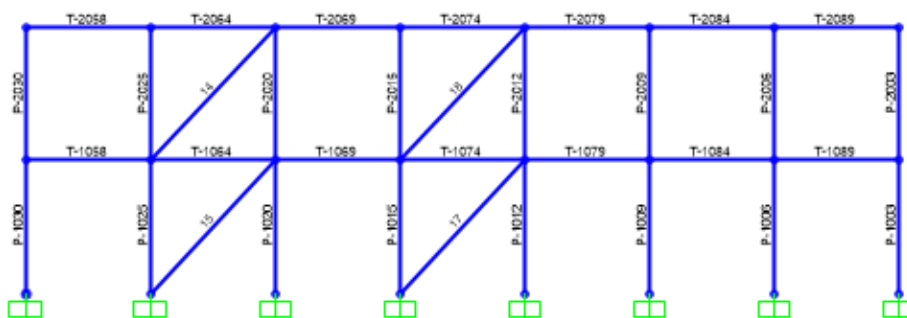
Disposizione dei controventi nel Telaio 2.
